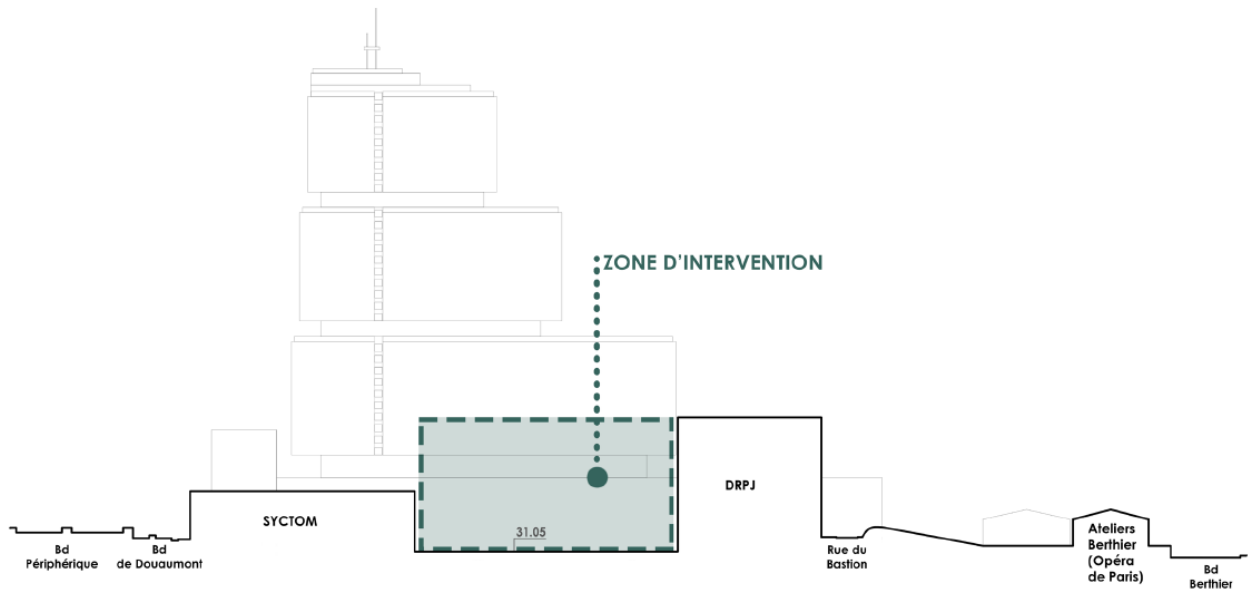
Coupe transversale de l'existant (source : DTACC)
